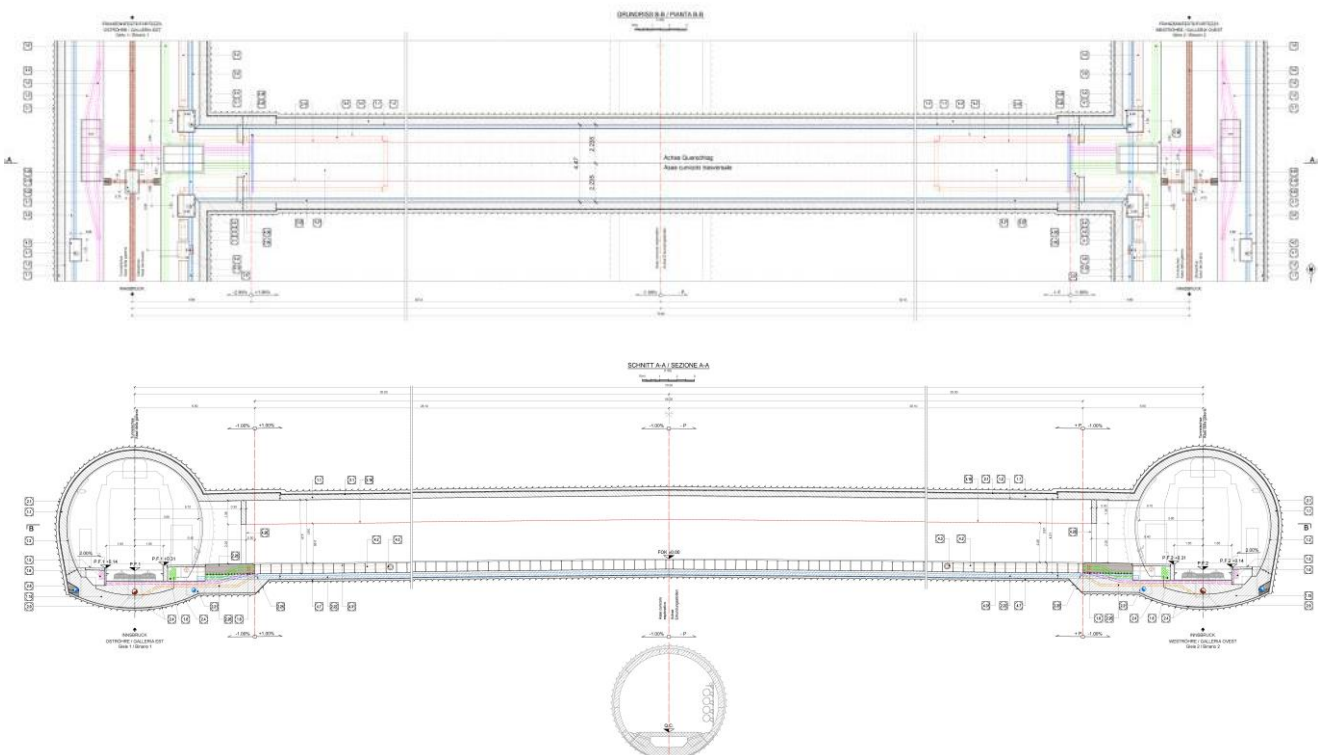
Querstollen Typ 1 - A) Grundriss, B) Längsprofil mit doppelter Neigung
